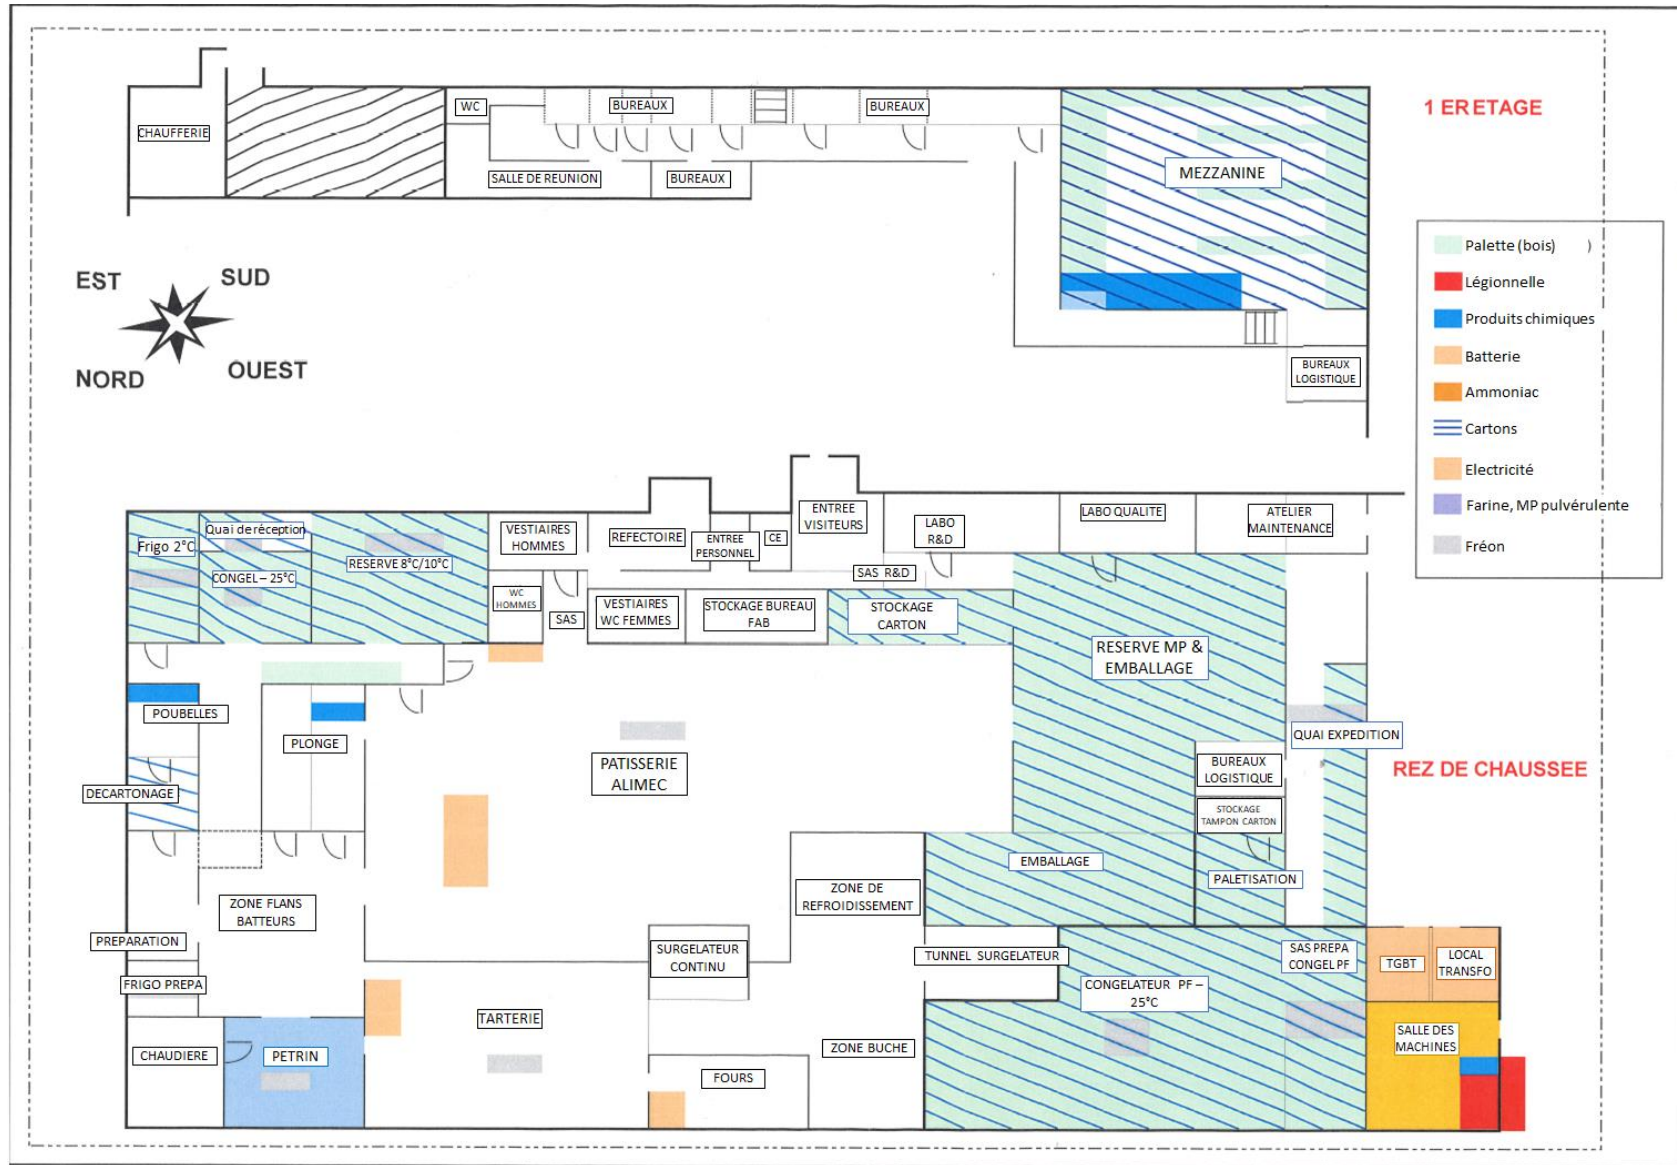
Plans des zones à risque du site Touflet Gourmet.
